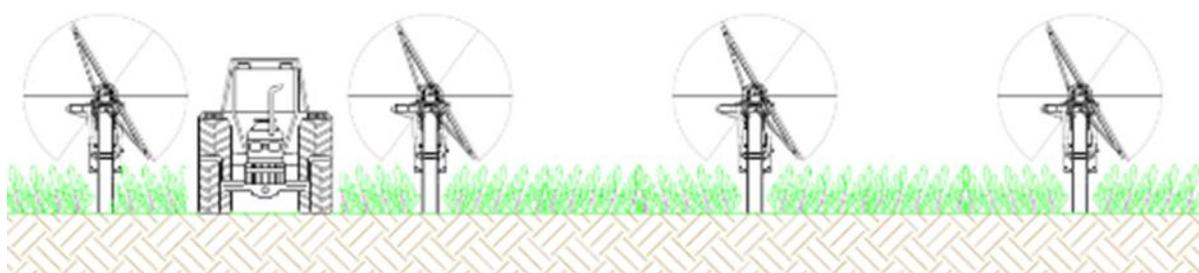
Particolare dello stato di progetto: distanza tra i tracker e transito dei mezzi meccanici (sezione trasversale).
